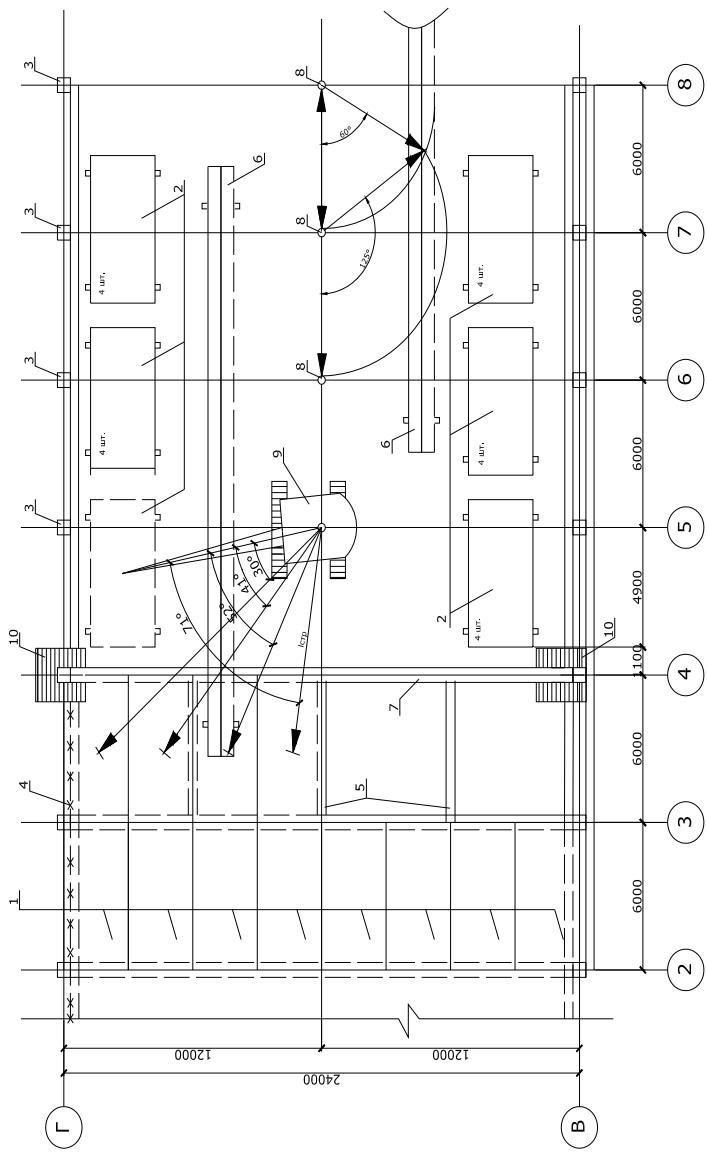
Технологическая схема монтажа конструкций покрытия и плит покрытия:
